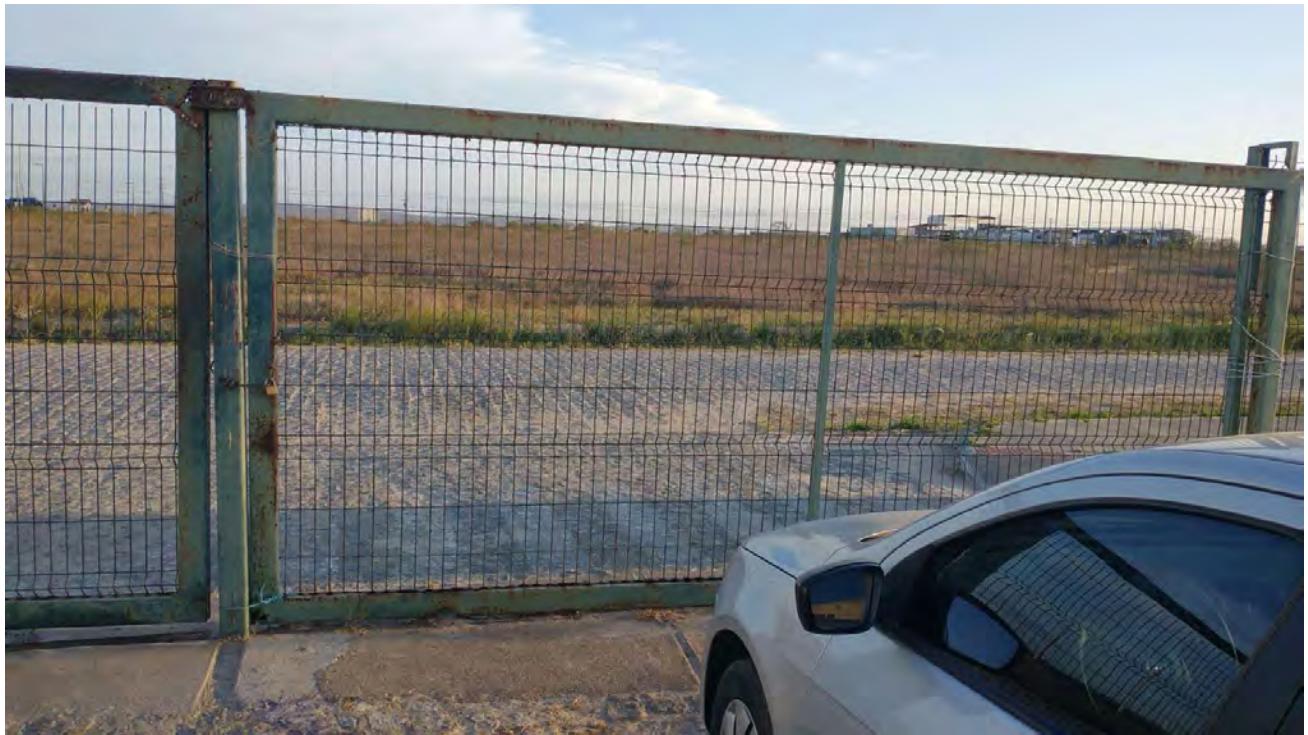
Vista do estado do portão do *campus Tobias Barreto
